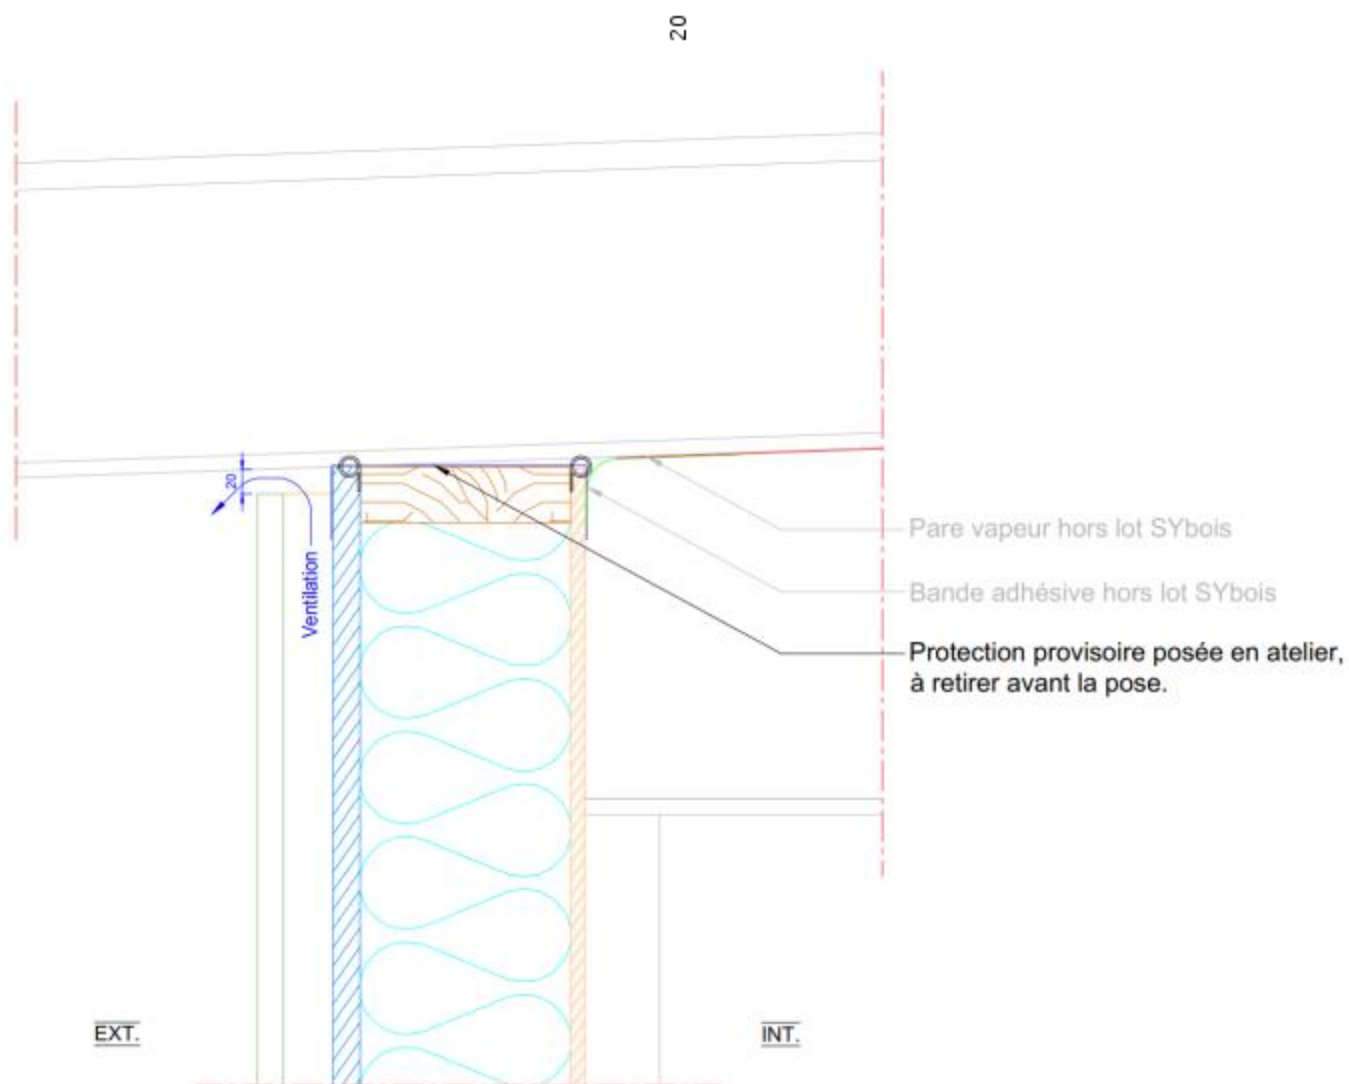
Tête de mur SYBOIS MUR – Jonction avec la toiture – Toiture préfabriquée
